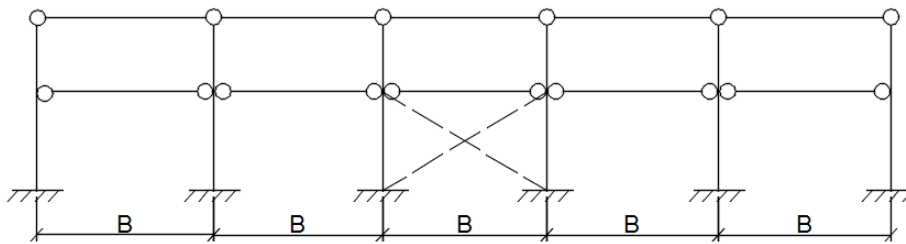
Схеми поперечних рам одноповерхових виробничих каркасних будівель із залізобетонних конструкцій:
